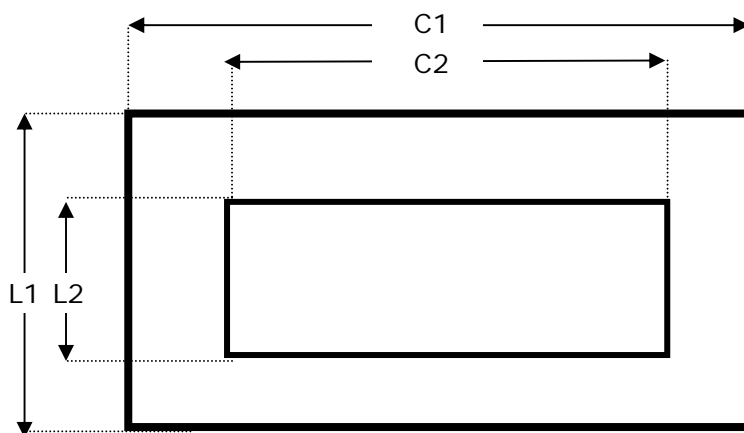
Planta de topo da escavação e dimensionamento da manta.
